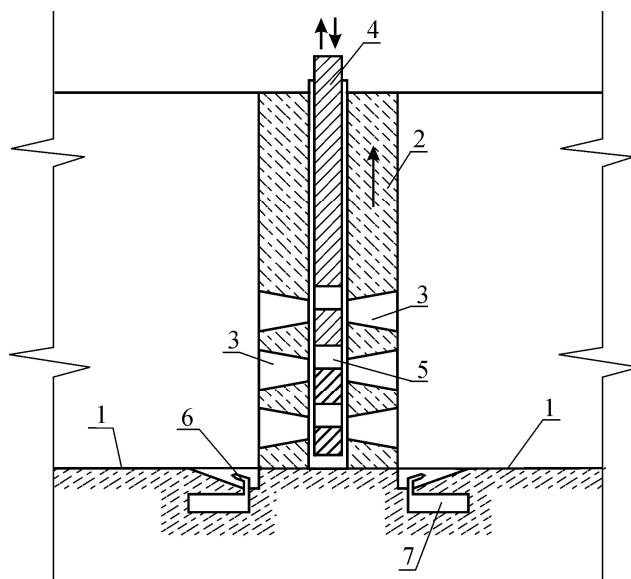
Схема механического рыбопропускного шлюза ПЭС на разрезе: 1 – рыбоходный тракт; 2 – рабочий затвор; 3 – клинкет; 4 – регулирующая шторка; 5 – водопропускные отверстия регулирующей шторки; 6 – струеобразующие насадки потокообразующего устройства; 7 – напорные коллекторы
